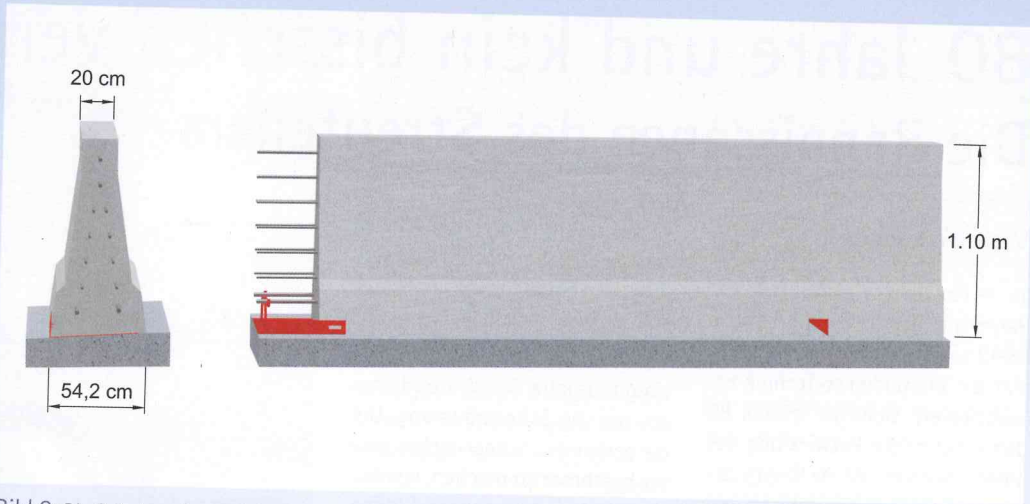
Die Ortbetonschutzwand LT 104, hier in der Variante für Bauwerke, bietet mit der Aufhaltestufe H4b höchste Sicherheit. Ein umfangreiches Programm an Modulen sowie an Übergangskonstruktionen und -elementen erlaubt den Anschluss an andere Betonschutzwände sowie an Stahlschutzplanken
